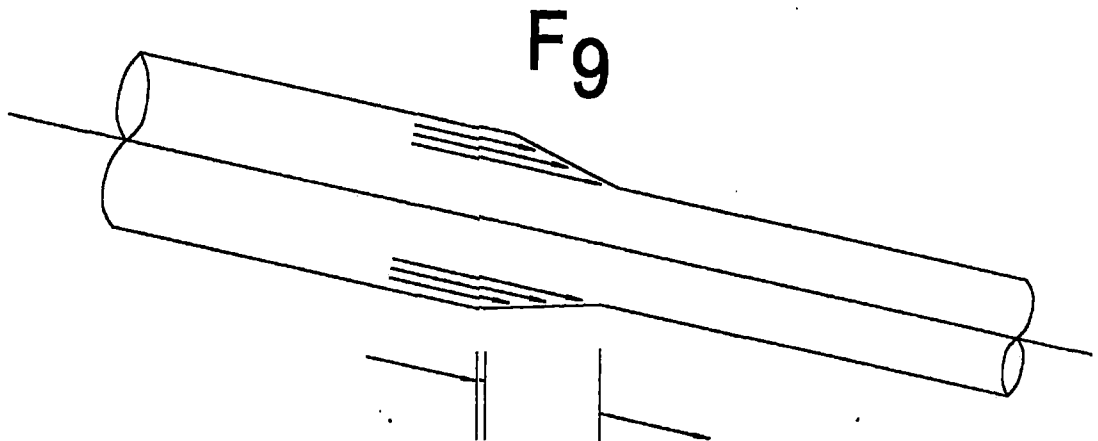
Fuerza F_9 para el diseño de los anclajes
